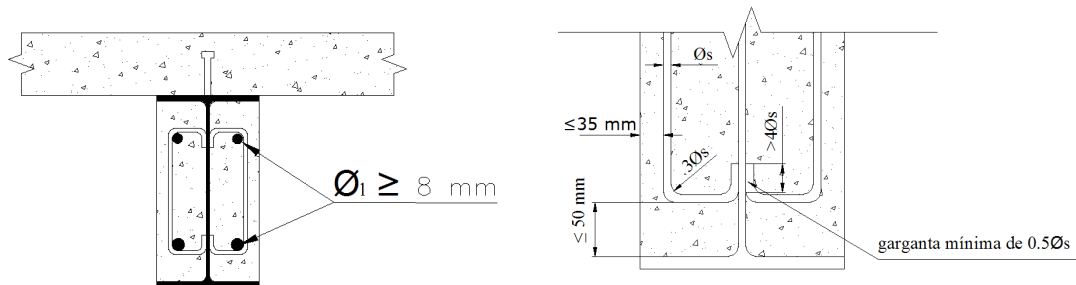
Detalhes construtivos para as VMCCs, com estribo soldado na alma do perfil.
